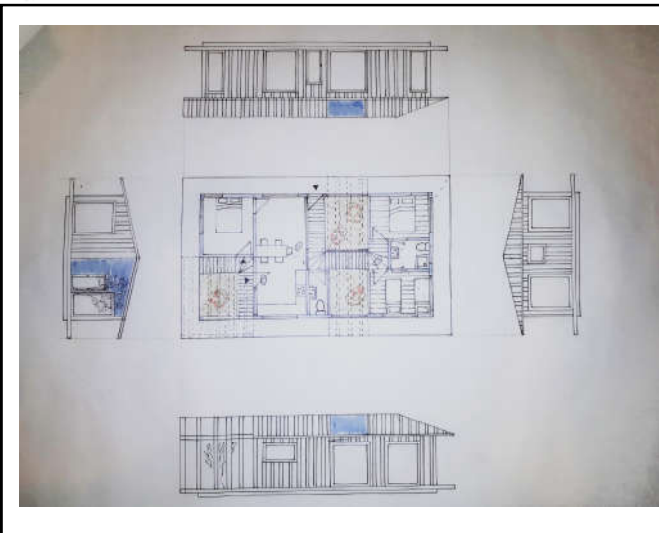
| Estudo de Fachada e Casa Pátio |
